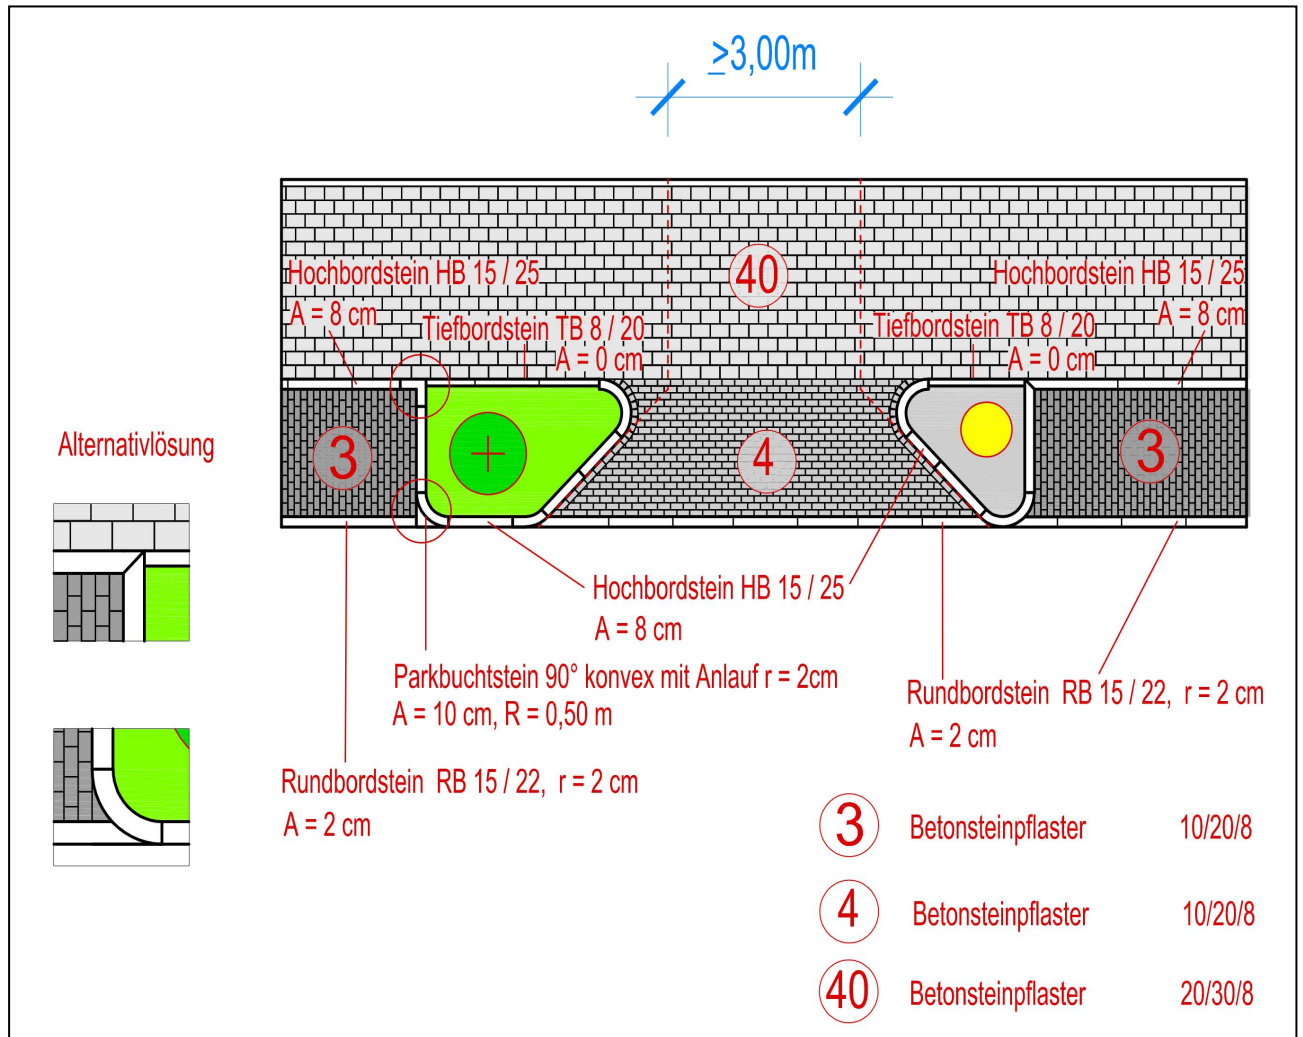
Grundstückszufahrt mit Parkstreifen, Baumscheibe und Leuchte
